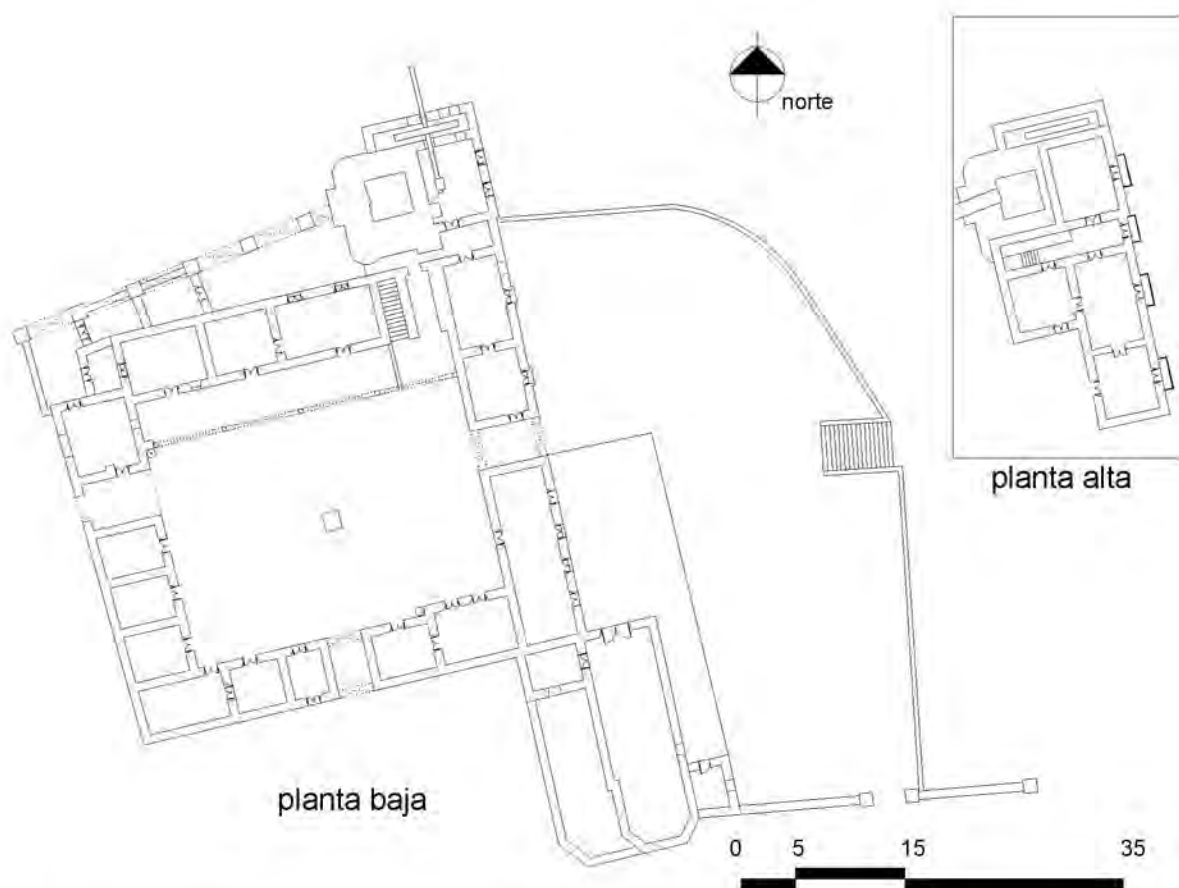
Planta de la casa de la hacienda de San Antón Guascamá. MADMP, CRJ 02
